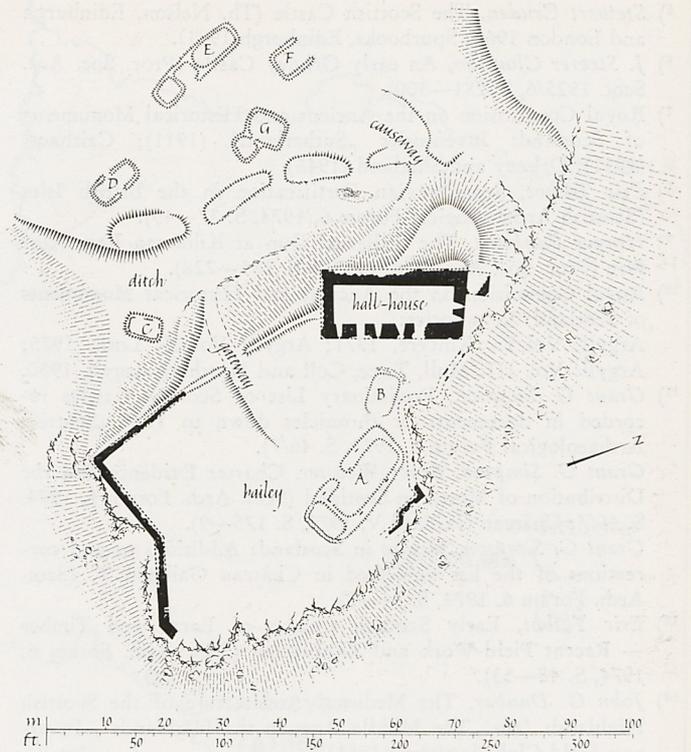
Aros Castle, Insel Mull. Lageplan mit Erdgeschoß des Hallenhauses, existentes 13. Jhdt.-Gemäuer schwarz; Westlich des Hallenhauses der Graben, östlich der Hof mit Resten der Ummauerung; Spuren von Innengebäuden (A/B) und Nebengebäuden (C-G), manche davon vermutlich jünger (RCAHMS, 54 Melville St, Edinburgh)
